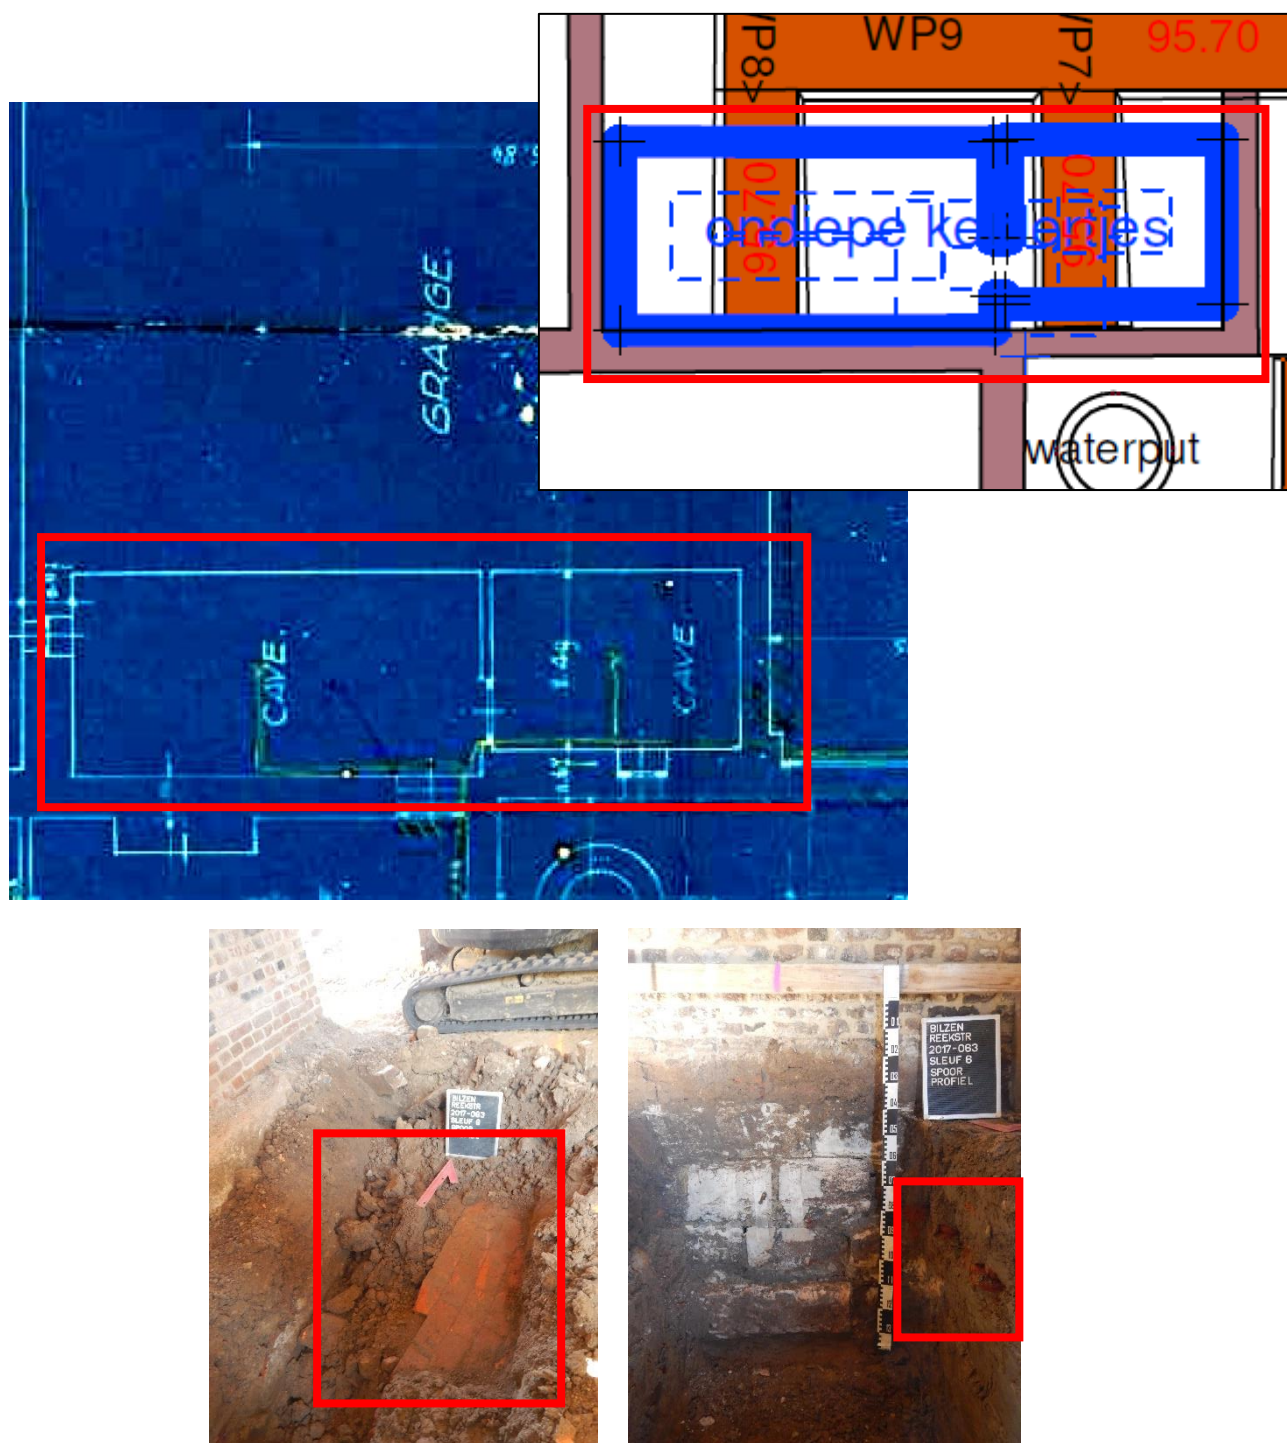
restanten van de keldervloertjes in vlak en in profiel telkens rood omkaderd en vergeleken met de situering op het plan uit 1931 en het allesporenplan.
